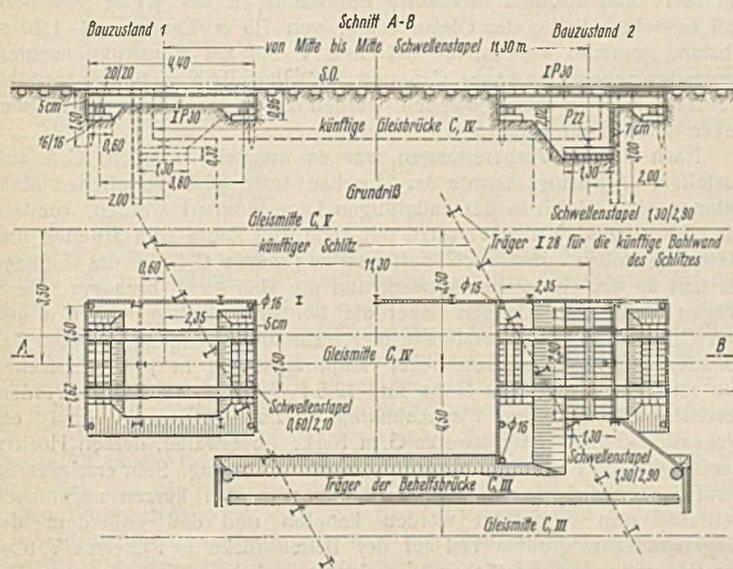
Einbau der Auflager für die Behelfbrücken bei Bauwerk C. (Beispiel: C, IV.)
